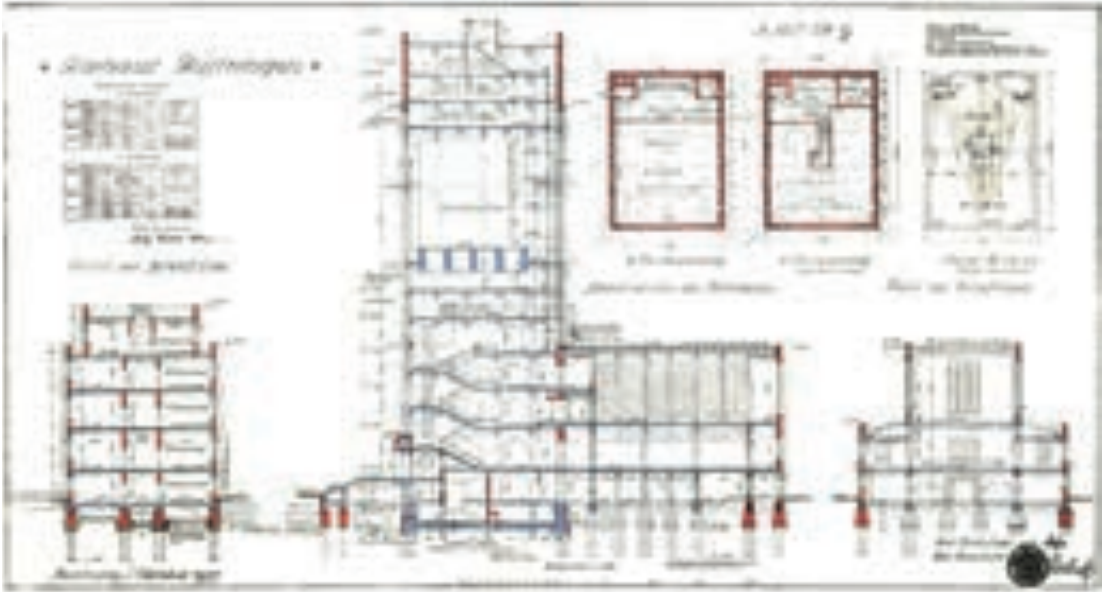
Fritz Högers Baupläne Ende der 1920er-Jahre: Längsschnitt und Grundrisse des 3. und 4. Turmgeschosses des Rathaussturms in Wilhelmshaven mit farbiger Kennzeichnung durch das Architekturbüro Griesemann, Wilhelmshaven: blau – Stahlbeton, rot – Mauerwerk
